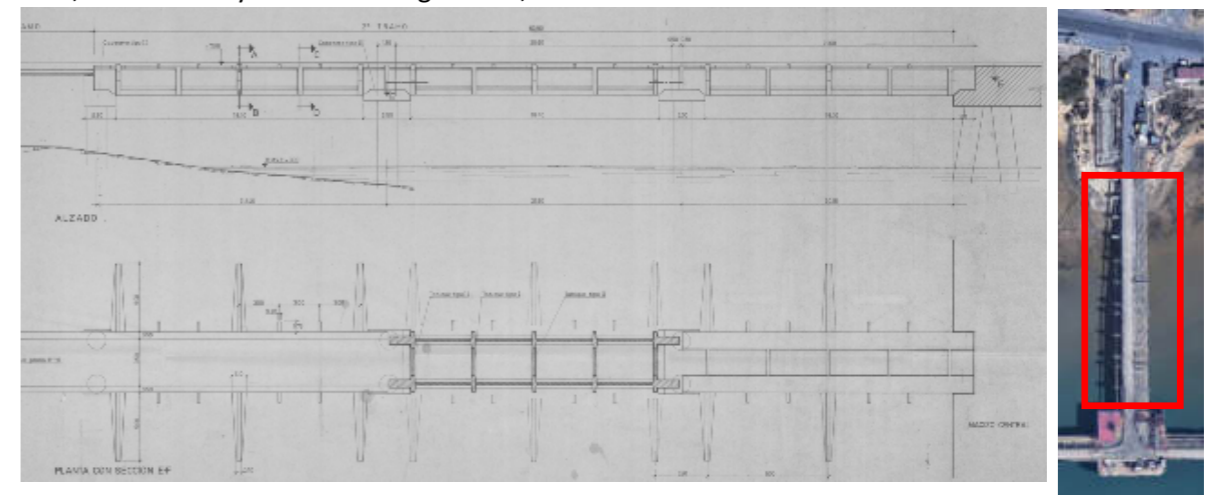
Tramo 2 de la pasarela de acceso - tramo agua (Fuente: Planos del proyecto constructivo)
